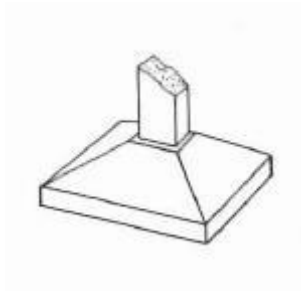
Tipos de fundações: Sapata Blocos de fundação.
